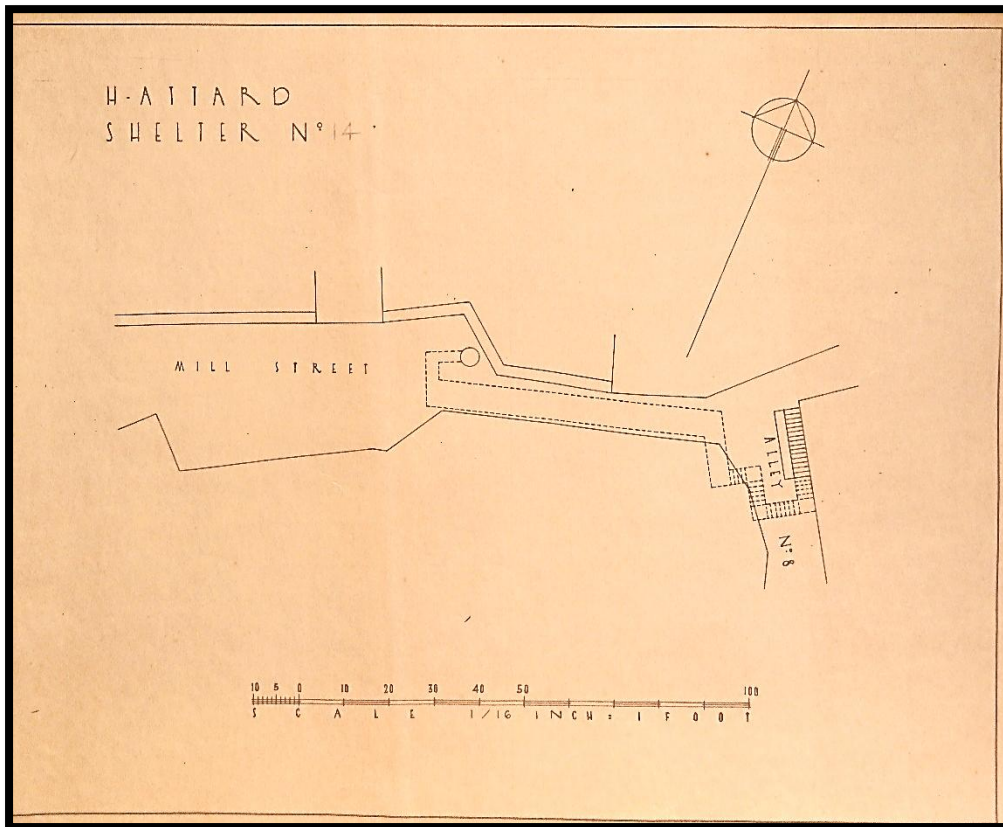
Planta do Abrigo nº14 "Mill Street – Alley nº8"
